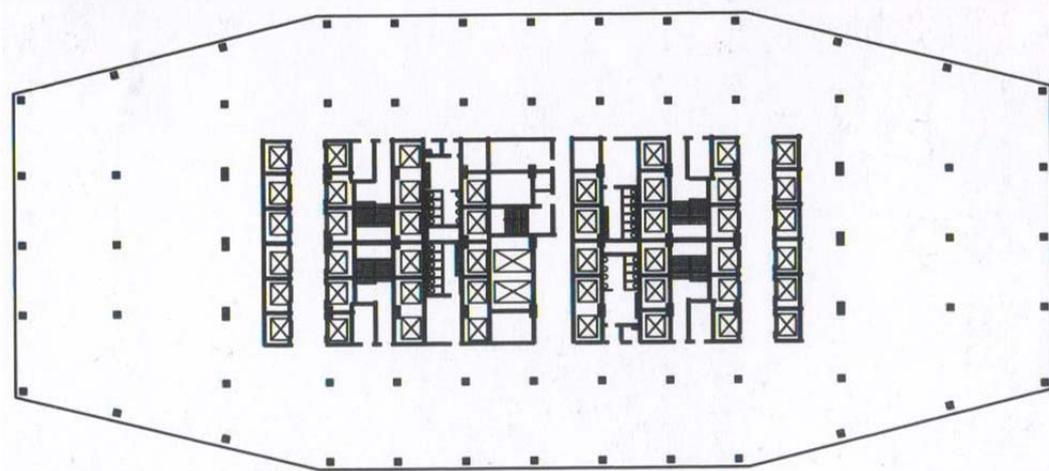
Planta do pav. tipo do edifício da Pan Am (1963) – Walter Gropius, Emery Roth e Pietro Belluschi
